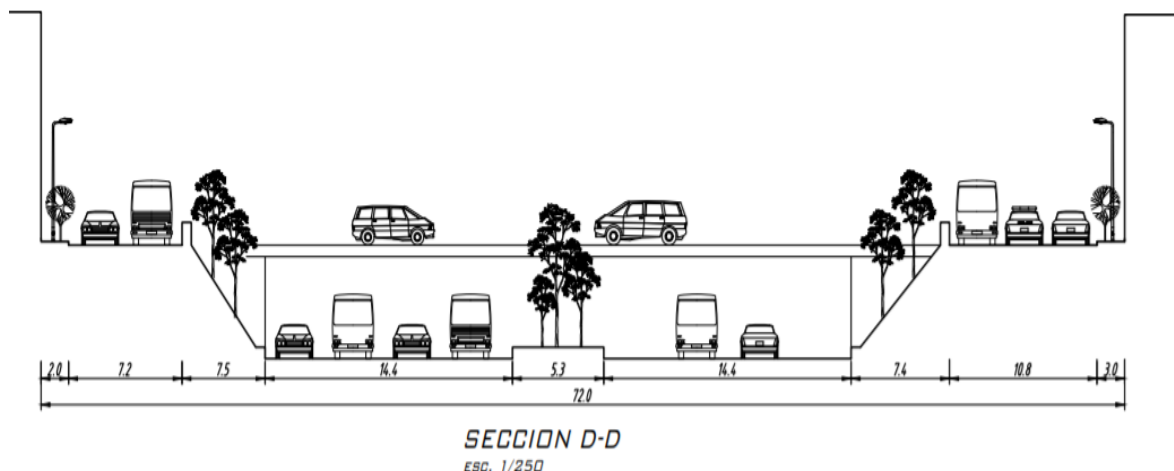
Sección transversal de Av. Néstor Gambetta, diamante tipo III en AutoCAD.
